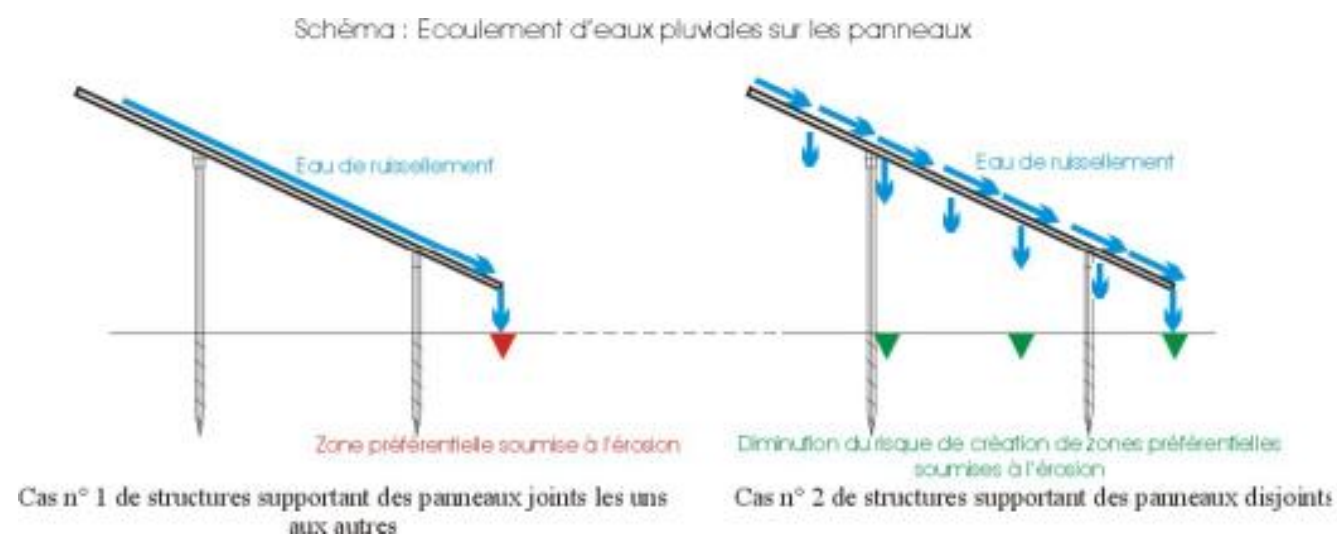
Schéma de principe des écoulements d'eaux pluviales sur les panneaux – effets des structures supportant des panneaux disjoints
